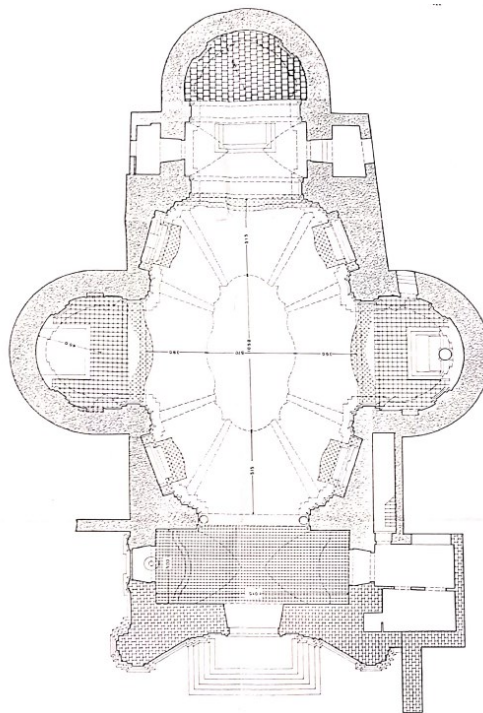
Rappresentazione dei materiali, pianta Chiesa Madonna del Carmine,
